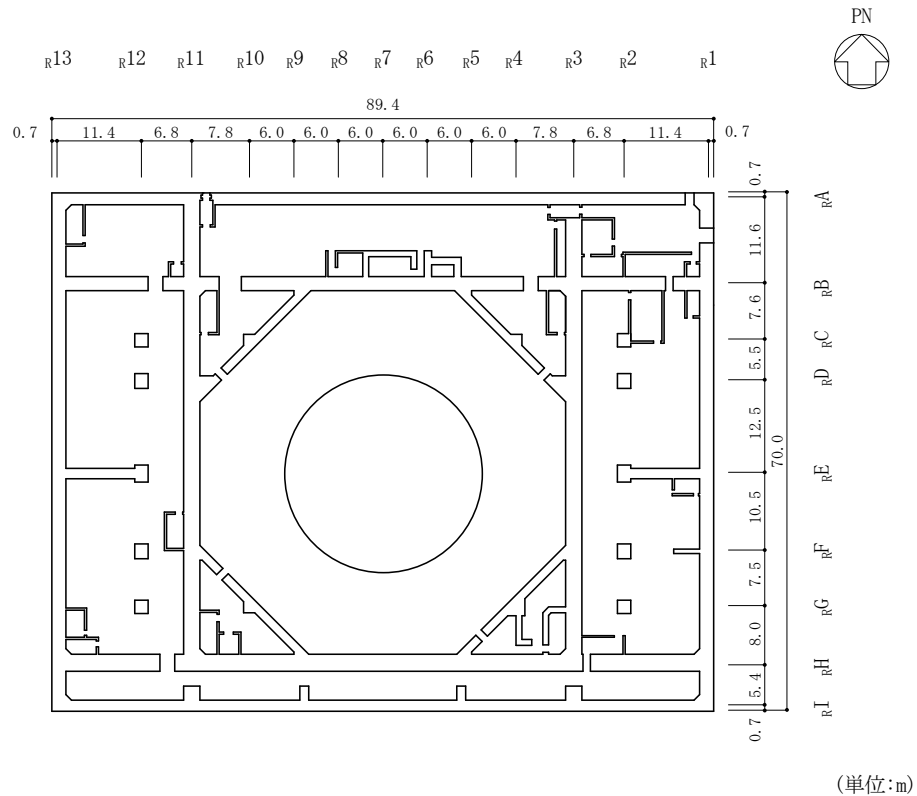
(2) 原子炉建物の概略平面図 (EL 8.8m)
